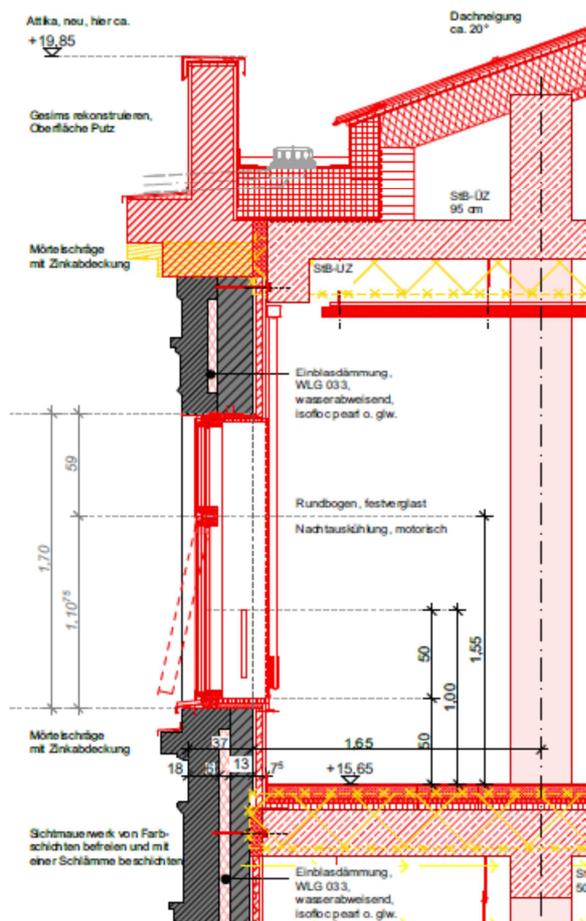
Denkmalgeschützte Fassade - Schnitt (Ausschnitt)
